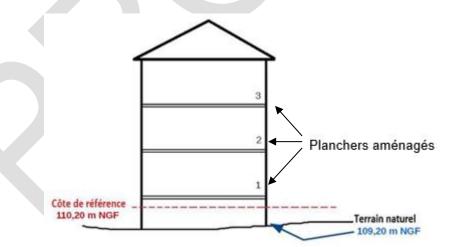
Construction avec 3 niveaux de planchers aménagés au-dessus de la cote de référence
